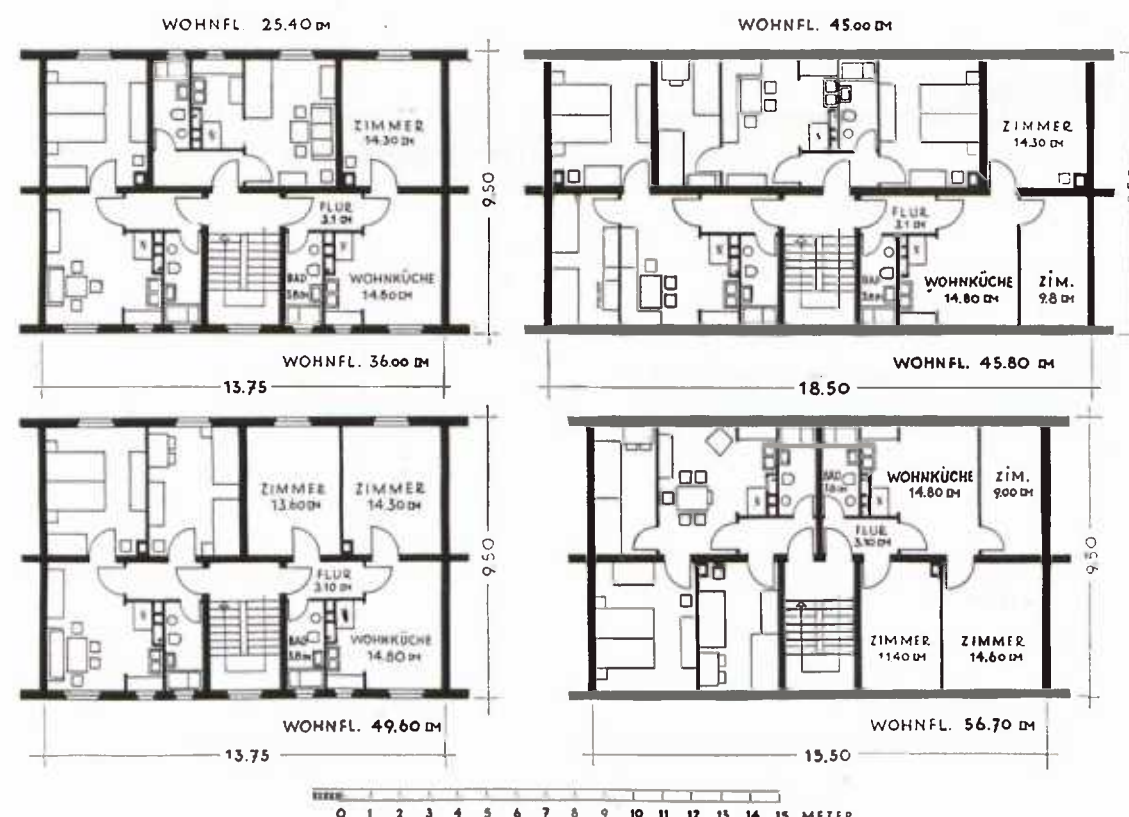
Grundrisse für das Neubauprojekt
